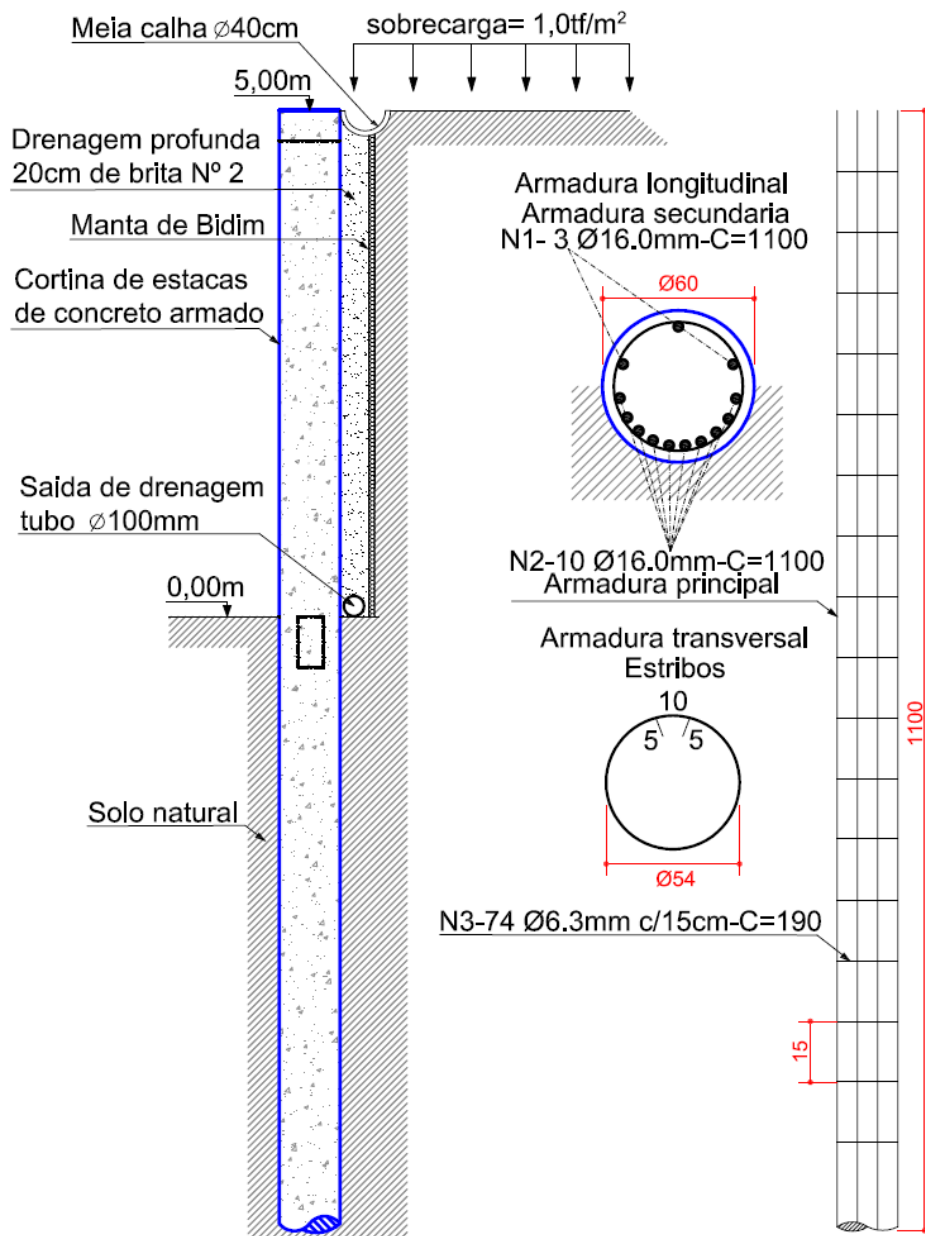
Detalhamento da cortina de estacas para o talude em estudo.
